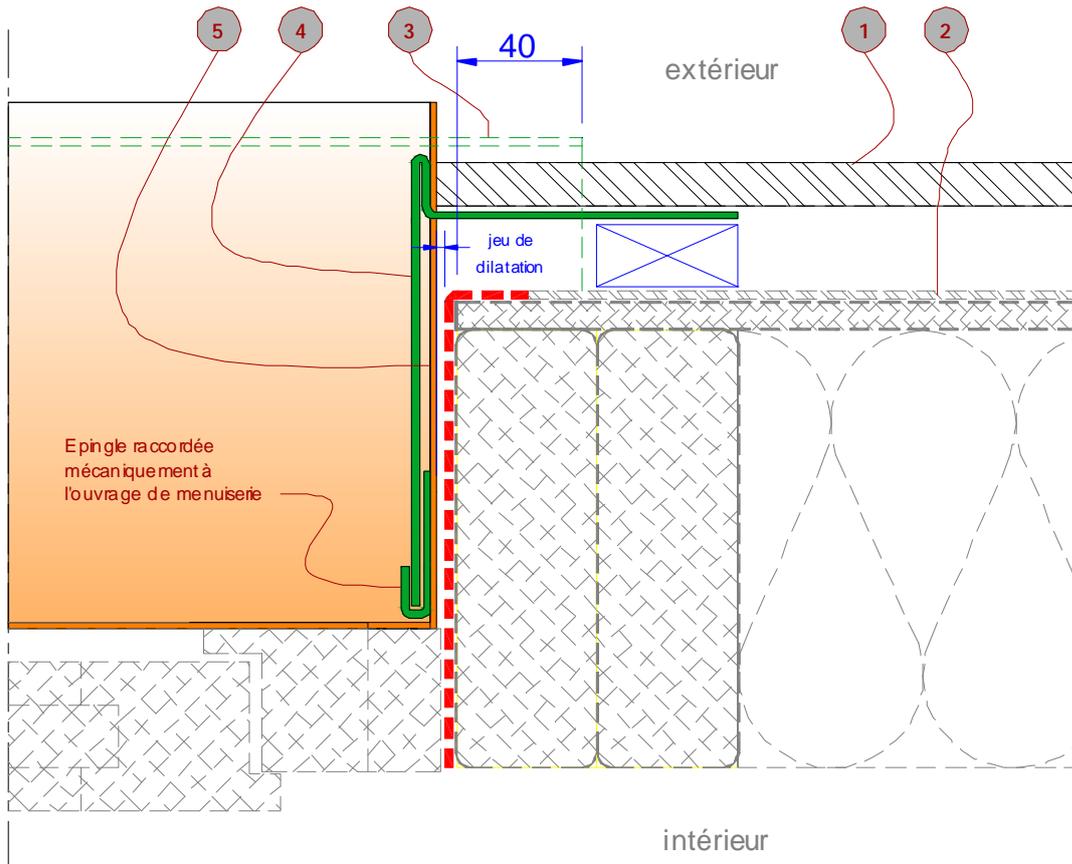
Pose sur COB – Coupe sur linteau de bai
